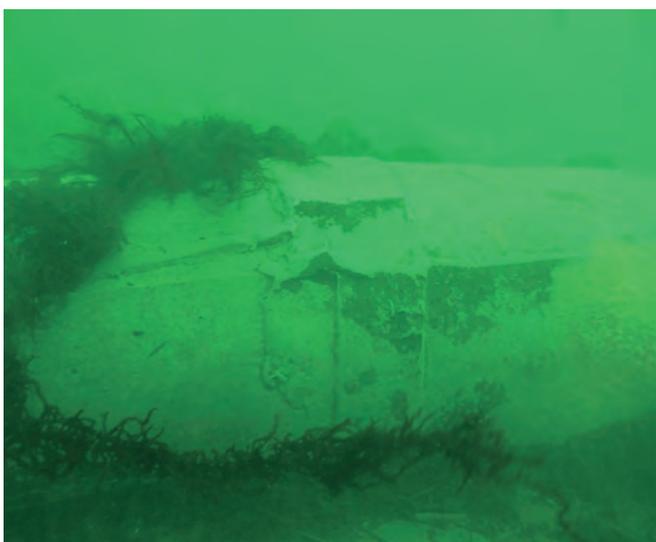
Tuyau à soudure plate de la double conduite RD10 et 11 (cl. L. Masselin).
